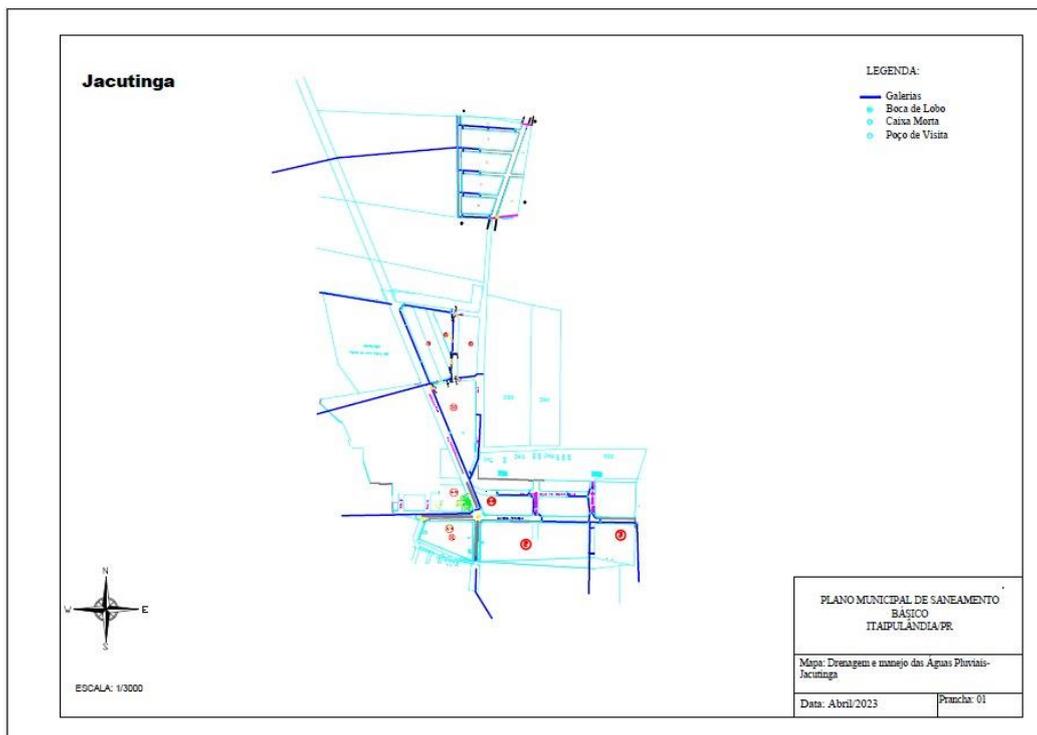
Sistema de drenagem do Bairro da Jacutinga.
